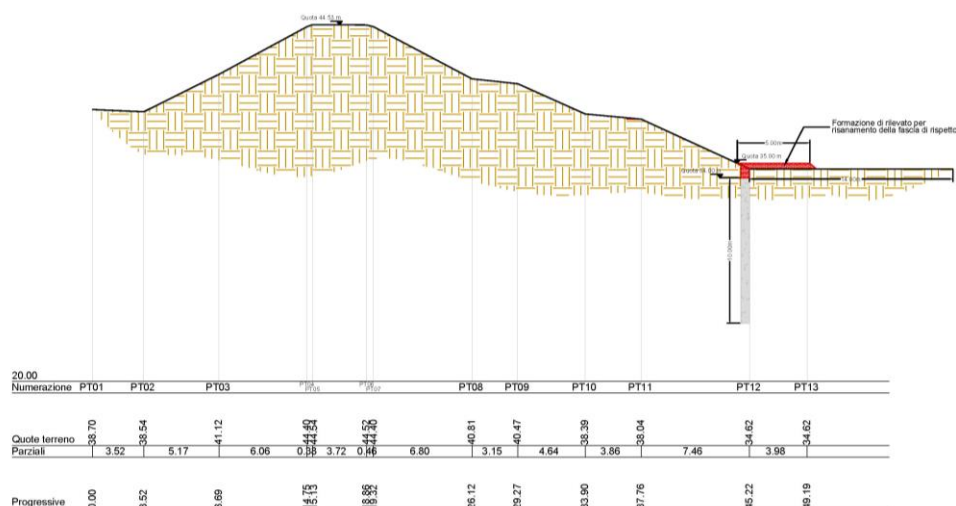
Località San Damaso stradello Cave Rubbiani (MO) - Sezione Tipo risanamento fascia di rispetto
